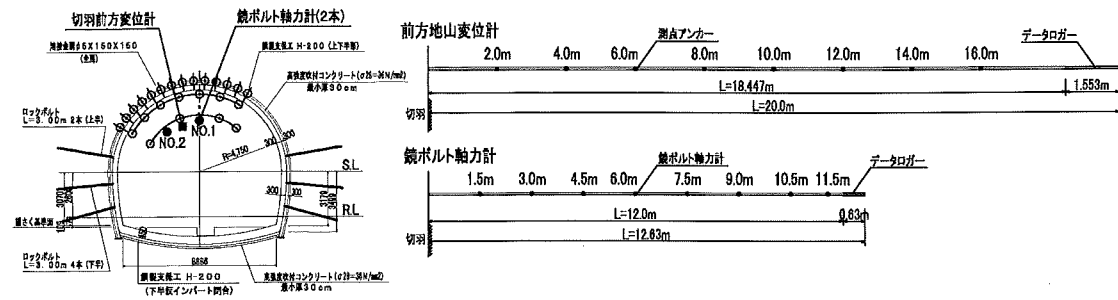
切羽前方地山変位計測および長尺鏡ボルト軸力計測配置図
